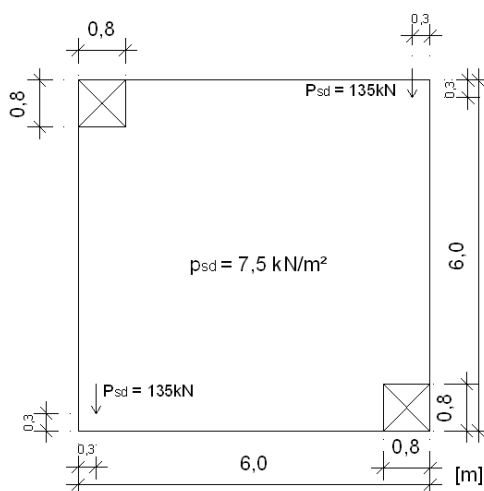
Laje apoiada em dois pilares sujeita a cargas uniformemente distribuídas e pontuais
